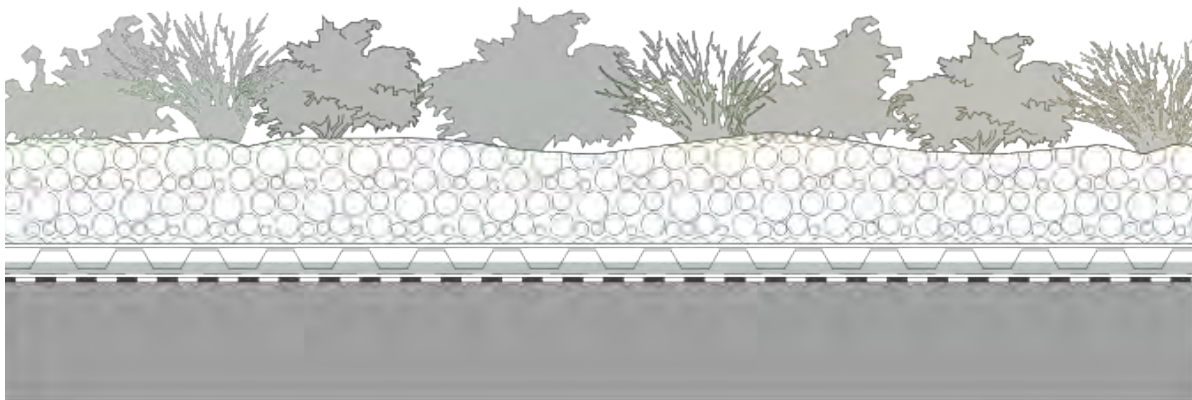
Aufbau extensive Dachbegrünung mit Drainageelement
